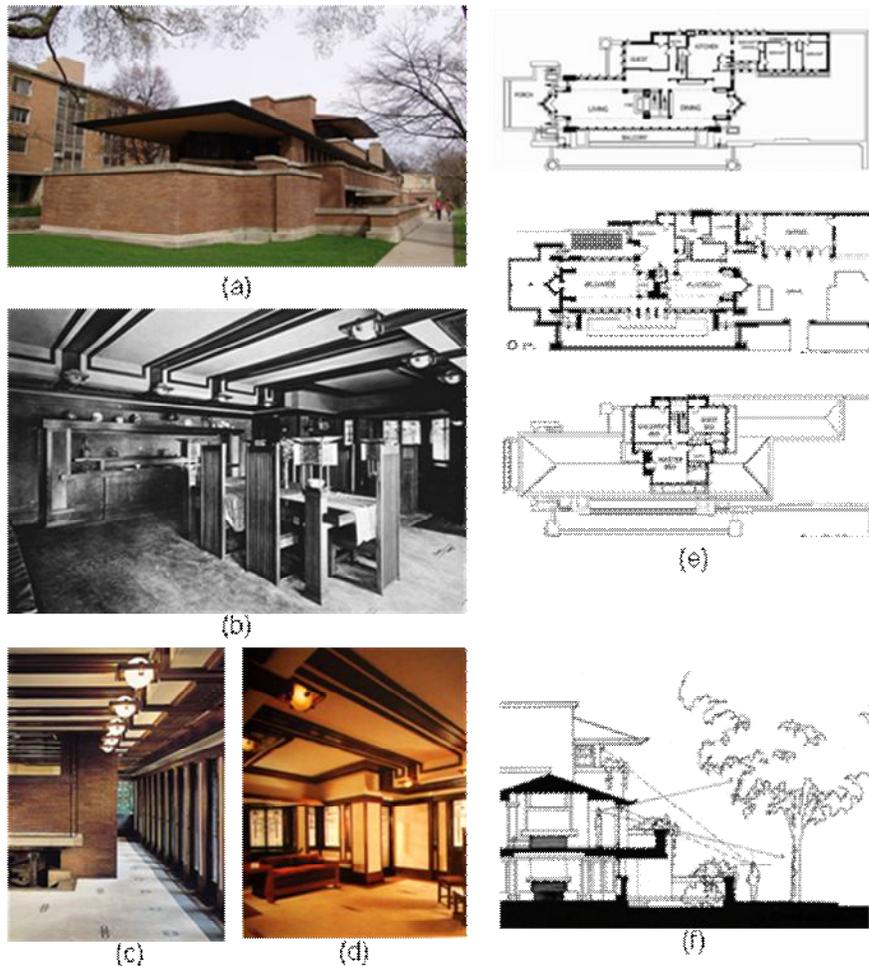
Frank Lloyd Wright, Casa Robie, South Woodlawn, Chicago, Illinois, E.U.A, (1908): (a) Vista exterior, (b) Detalle interior – comedor, (c) Detalle interior - Vestíbulo con vista a chimenea, (d) Detalle interior – Estancia social, (e) Plantas arquitectónicas, (f) Sección transversal.
